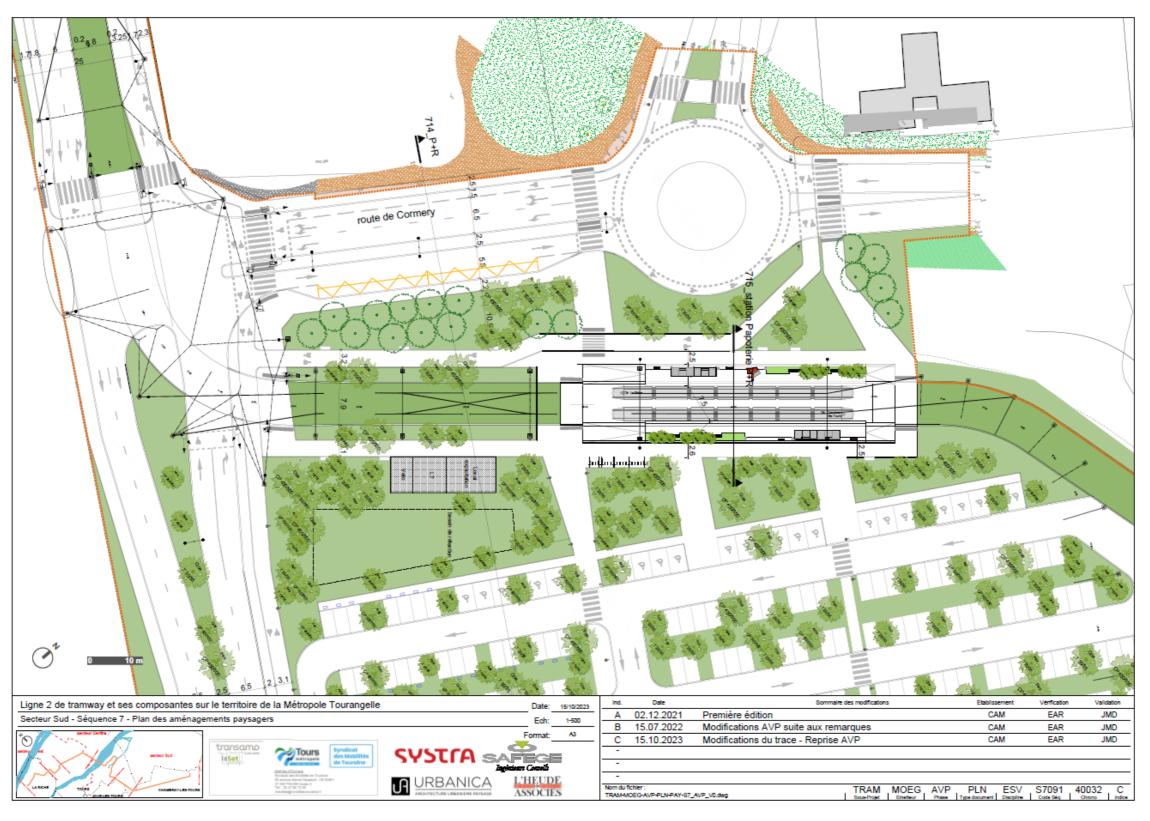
plan masse de localisation des arbres à abattre – P+R La Papoterie (planche 19)
